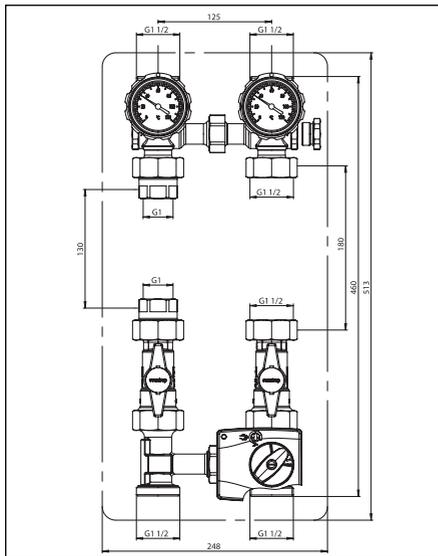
Abmessungen für Wärmemengenzähler 130 mm
